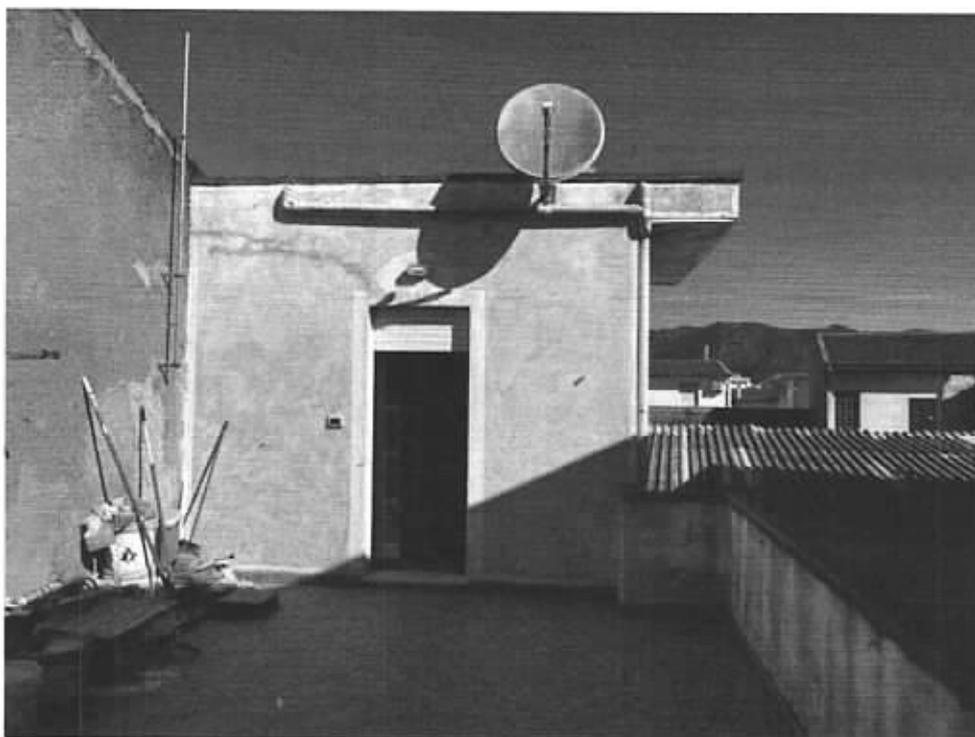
Piano primo - porta accesso terrazza (26/09/2023)
